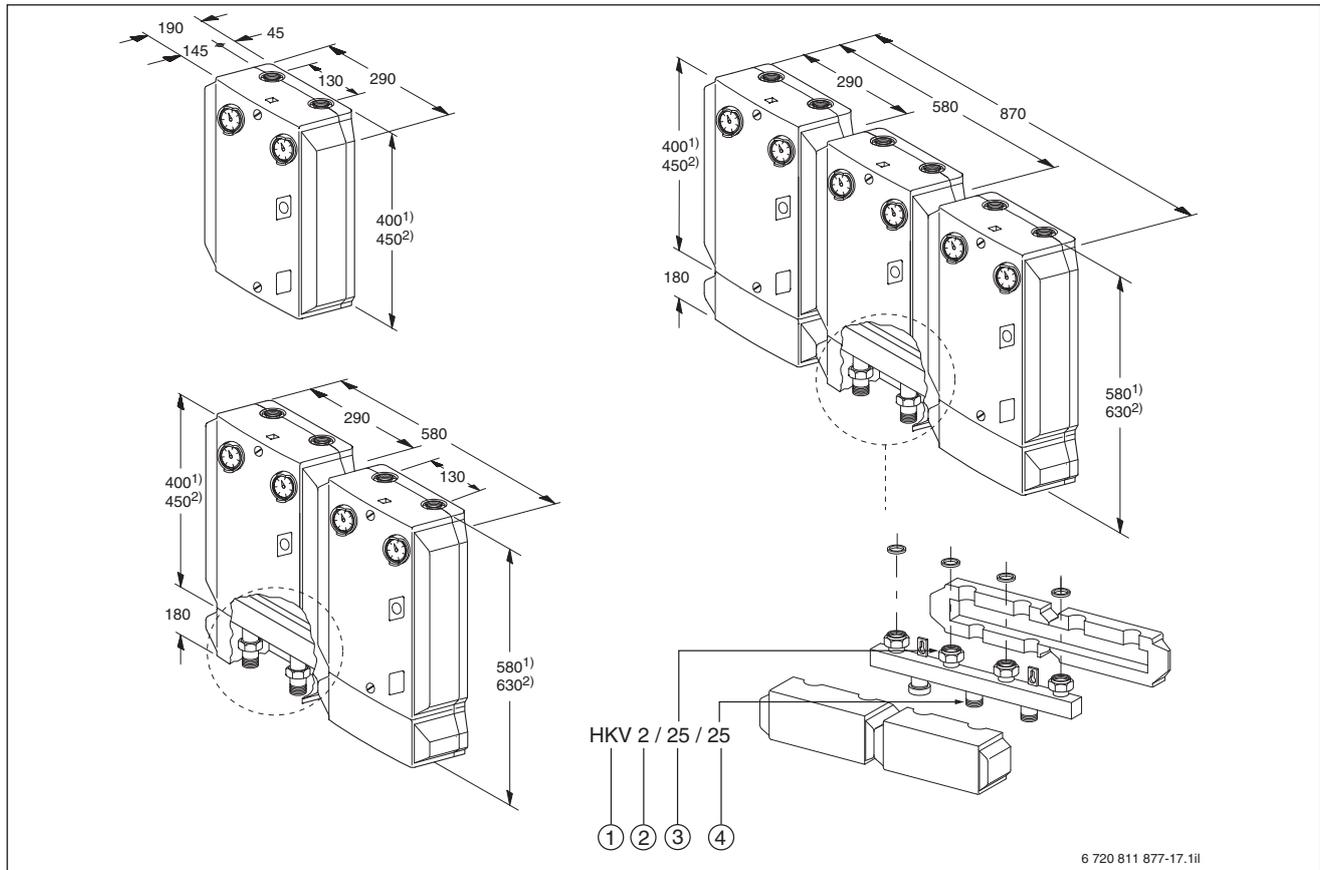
Abmessungen Heizkreis-Schnellmontage-Sets und Heizkreisverteiler (Maße in mm)
